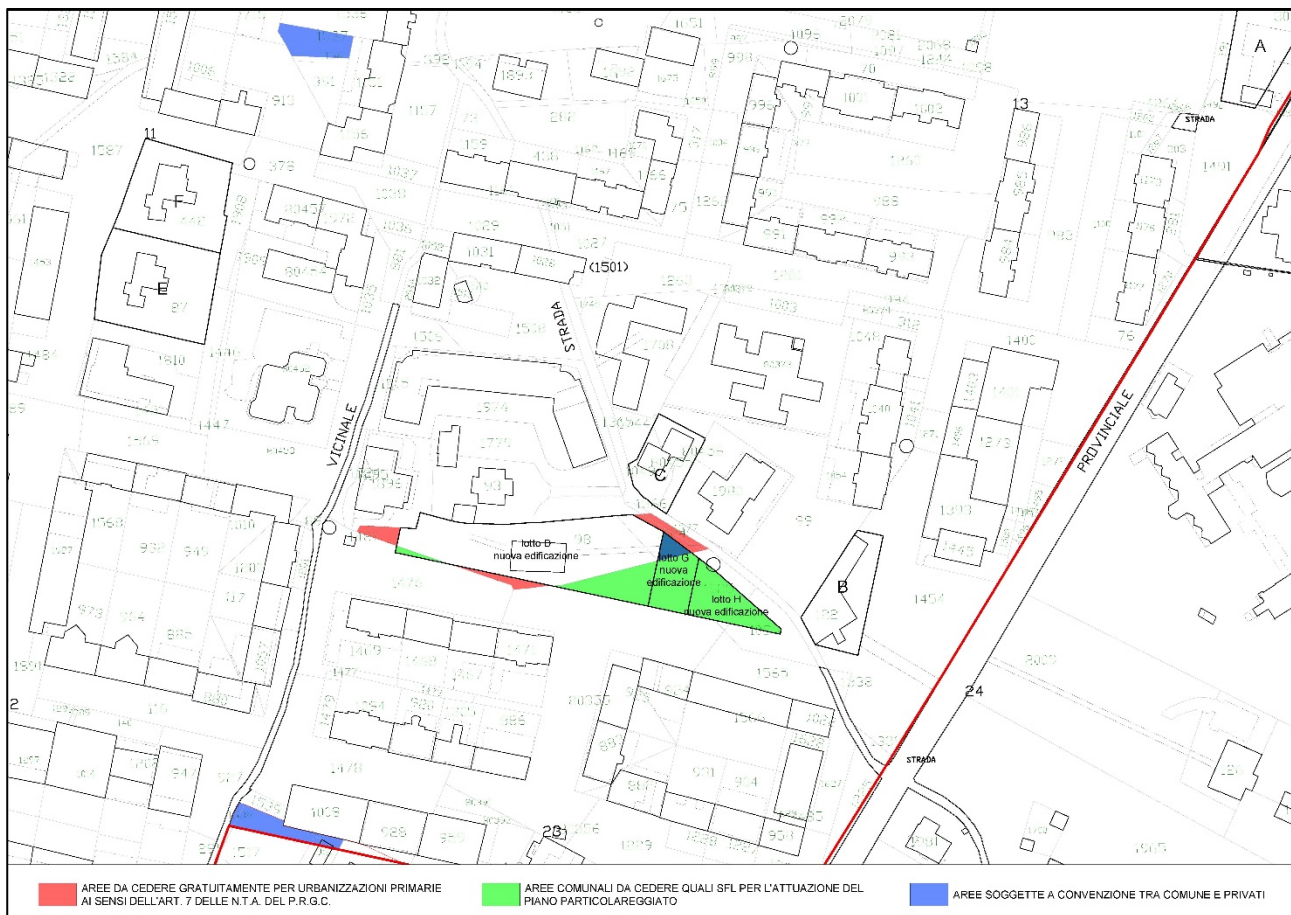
Cessione delle aree private e area per il nuovo intervento.
